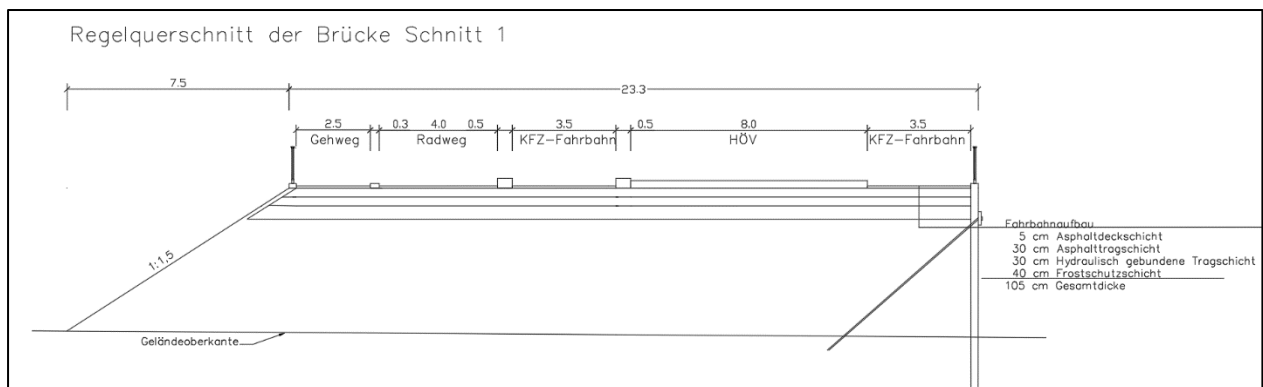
Regelquerschnitt der geplanten Überführung Preetzer Straße
